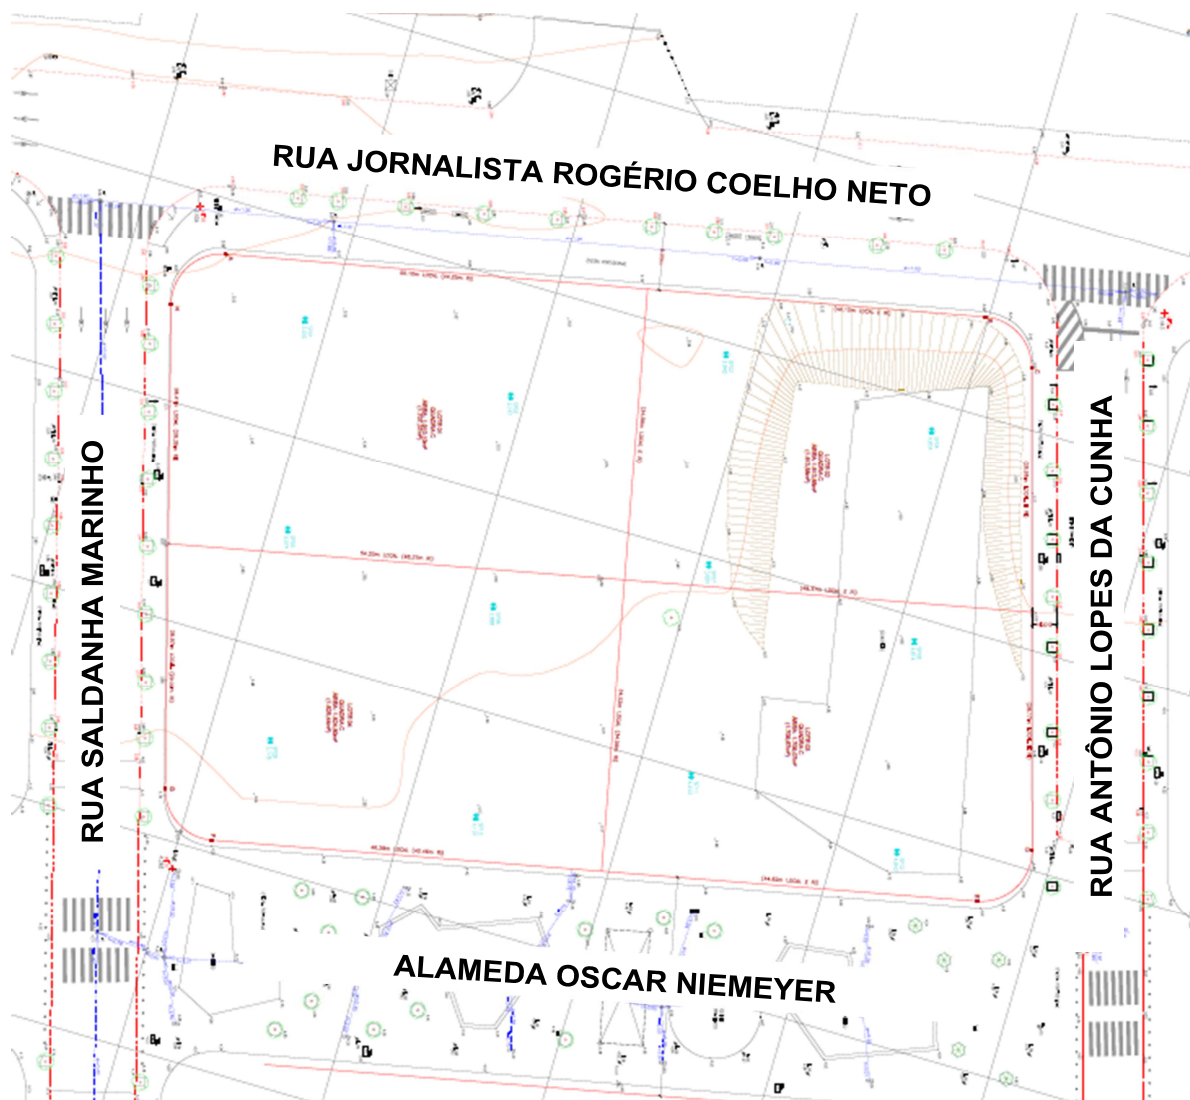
Levantamento Topográfico Planialtimétrico do terreno
